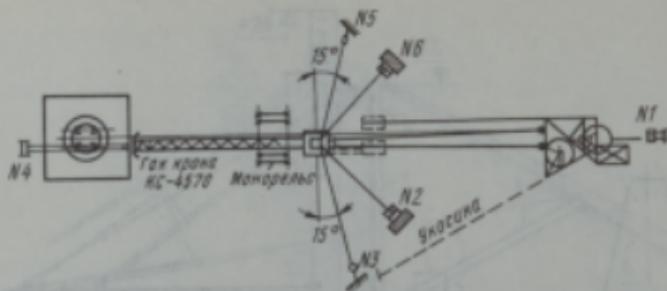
Расположение подъемных лебедок на монтажной площадке
